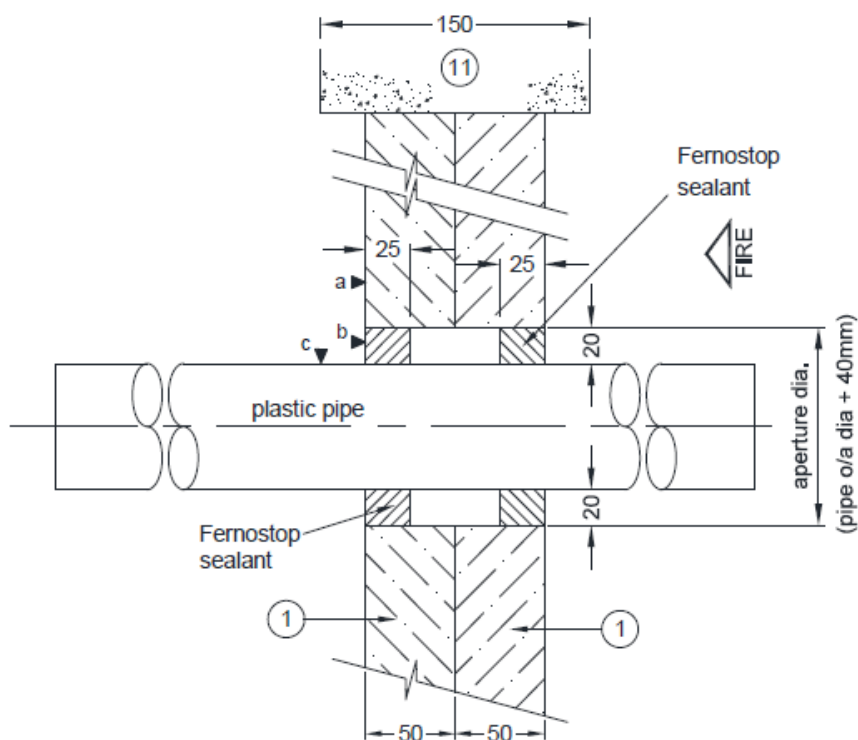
Niet-verhitte zijde met doorvoeringen – proefstuk A (afmetingen in mm)
